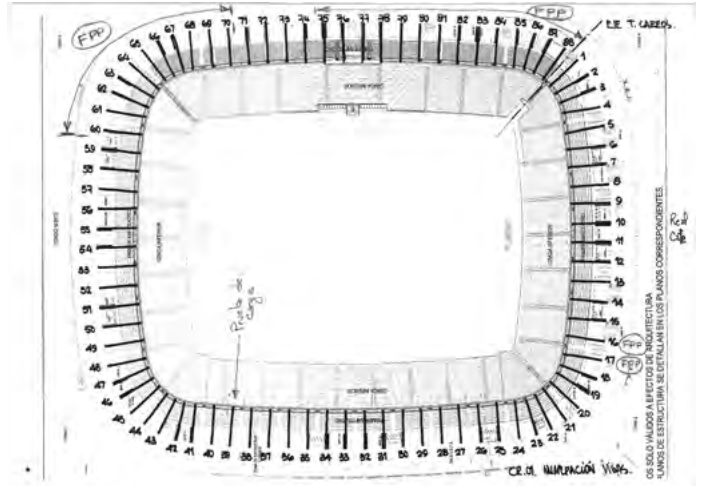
Planta estructural del primer anfiteatro. Situación de los 88 pórticos.
